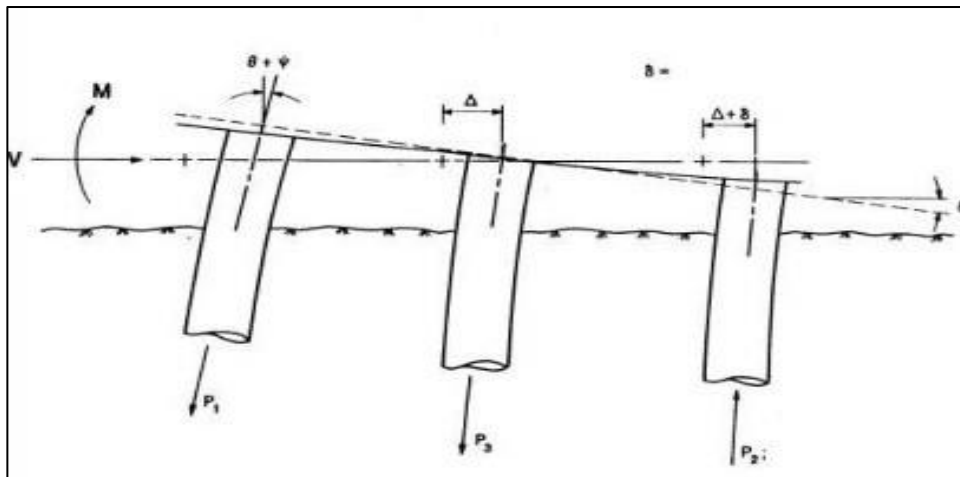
Comportement d'un groupe de pieux verticaux sous chargement transversal. [O'Neill & Al. 1985].
